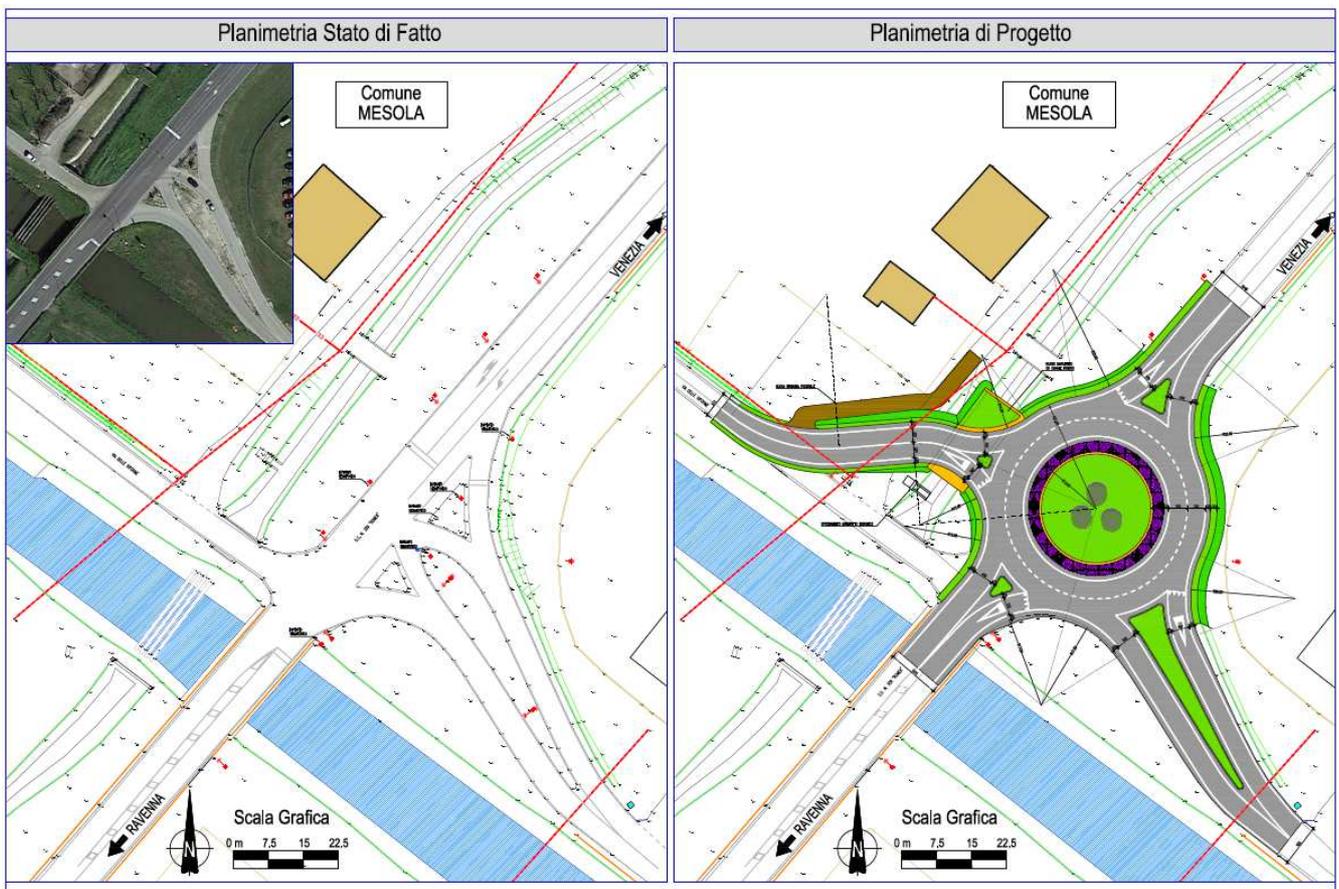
Intervento n°19 – Planimetria Stato di fatto - Progetto
